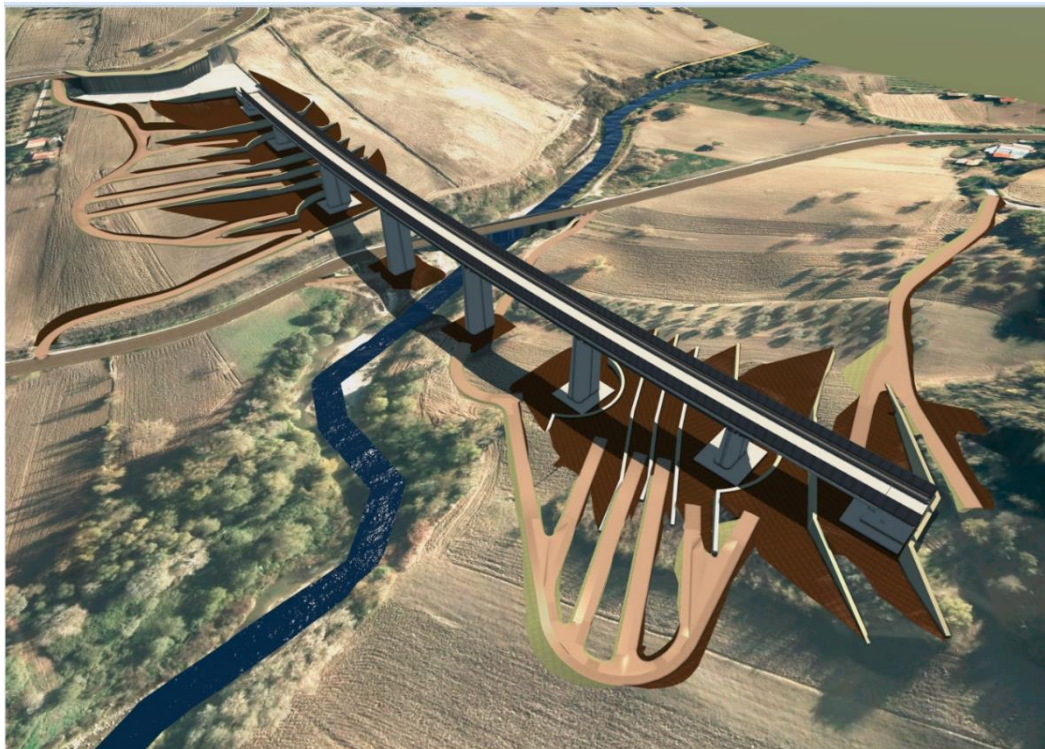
Viadotto VI03: Inserimento del modello BIM tridimensionale nel modello digitale del terreno e studio delle modalità di accesso alle aree di lavoro per la realizzazione delle opere di fondazione delle pile e delle spalle.
